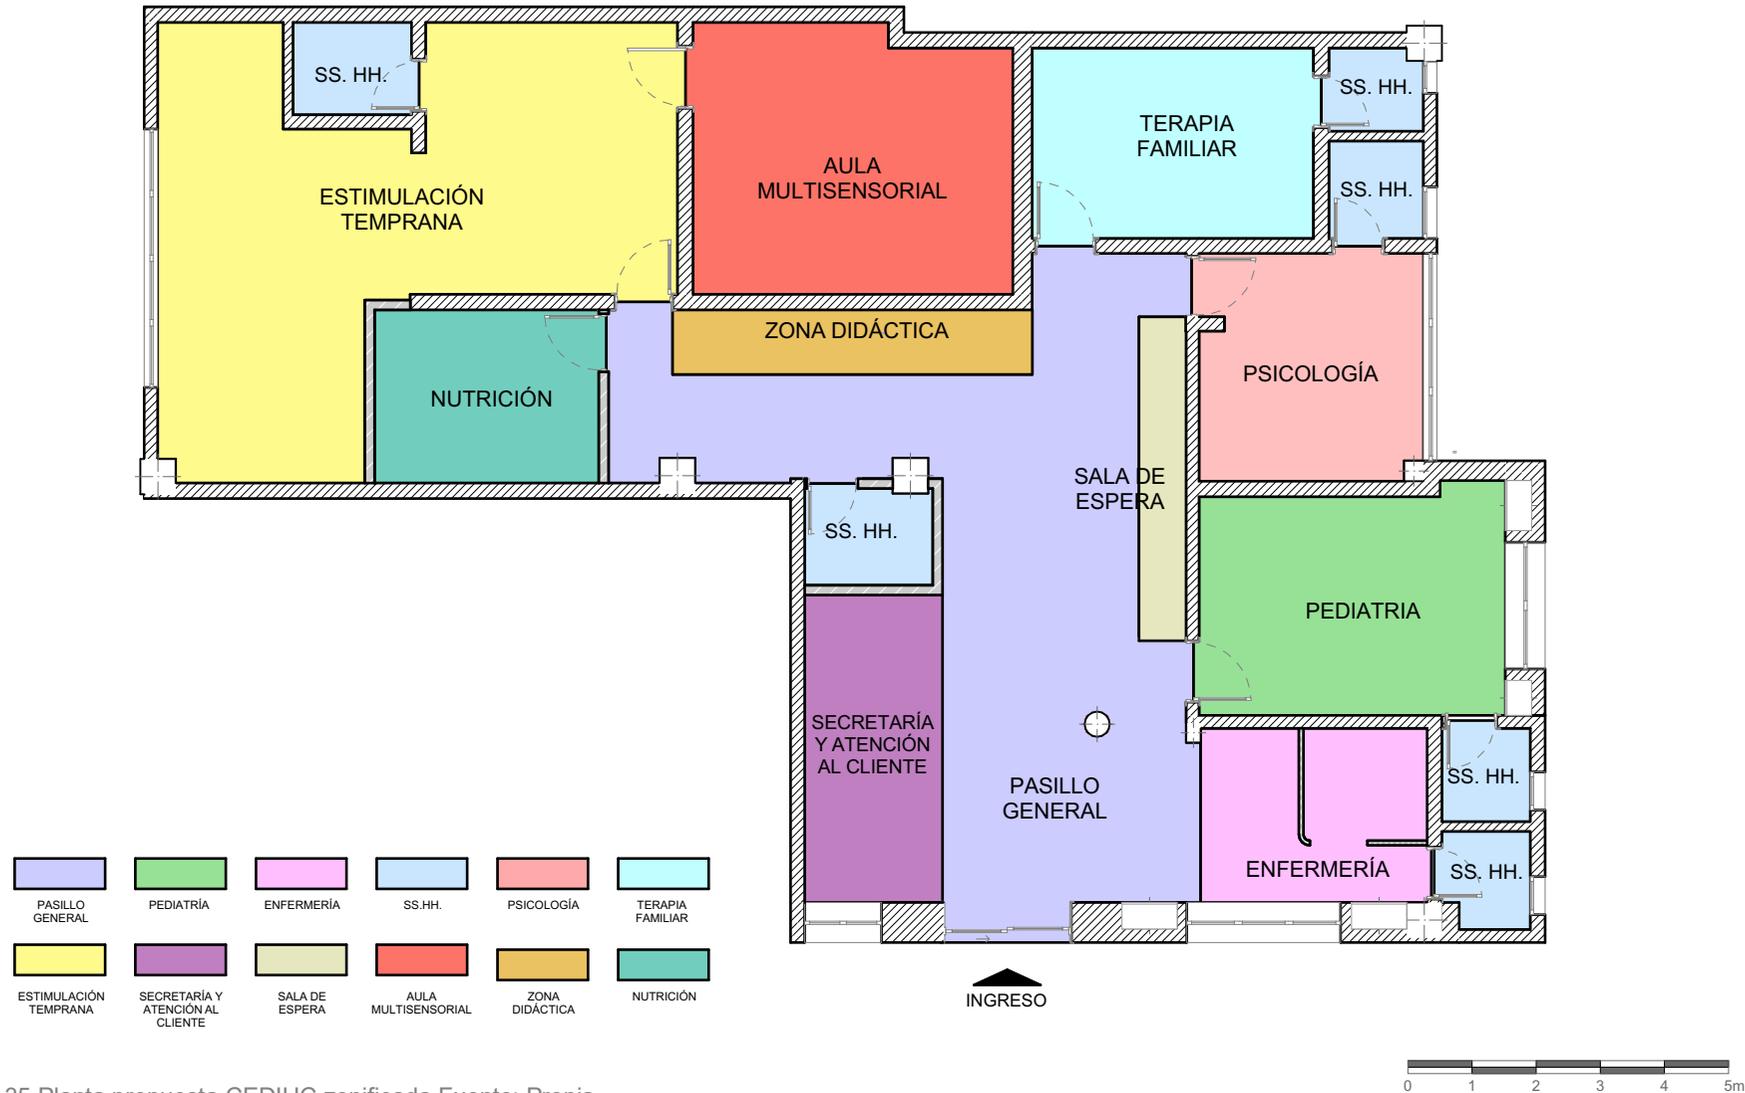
Planta propuesta CEDIUC zonificada Fuente: Propia
